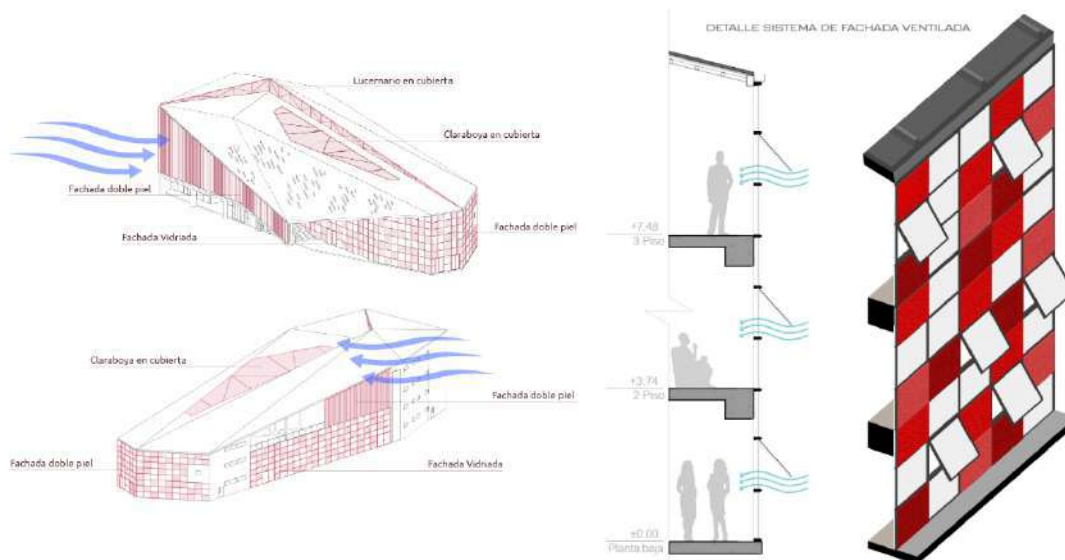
Detalle de propuesta de Sistema de fachada ventilada
